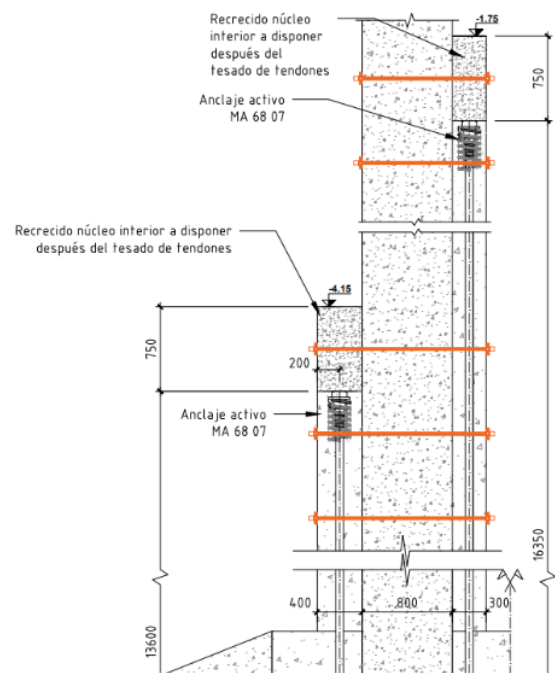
Sección horizontal con barra Dywidag 36WR en núcleos
